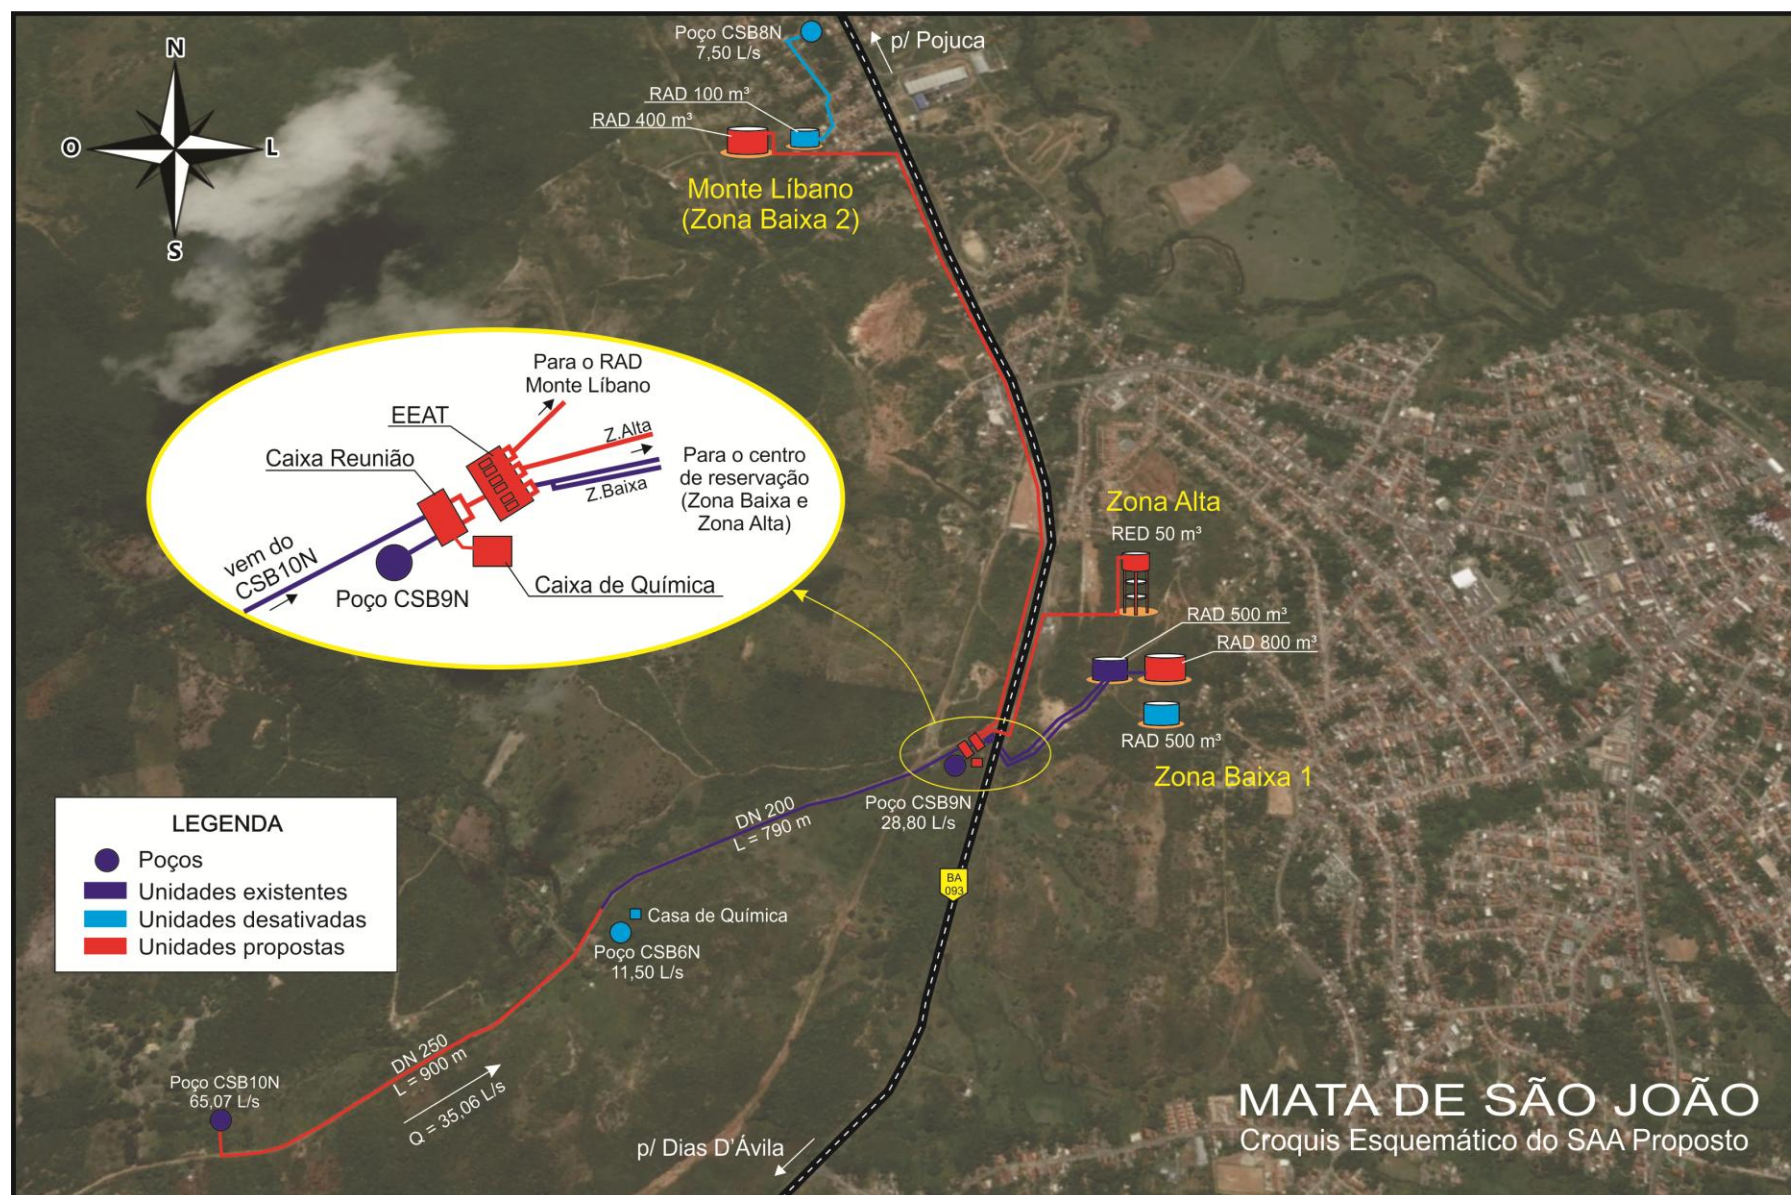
Sistema de Abastecimento Proposto para Mata de São João (sede)
